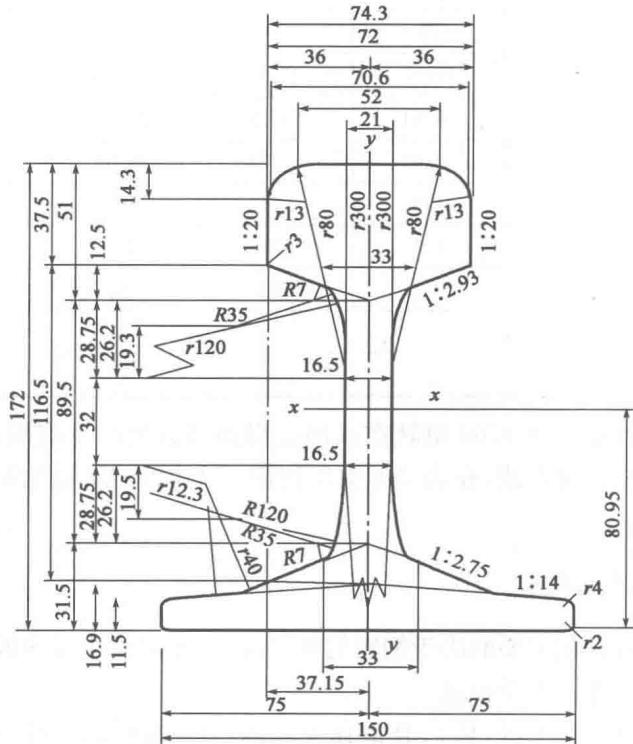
UIC60 钢轨断面图(尺寸单位:mm)
